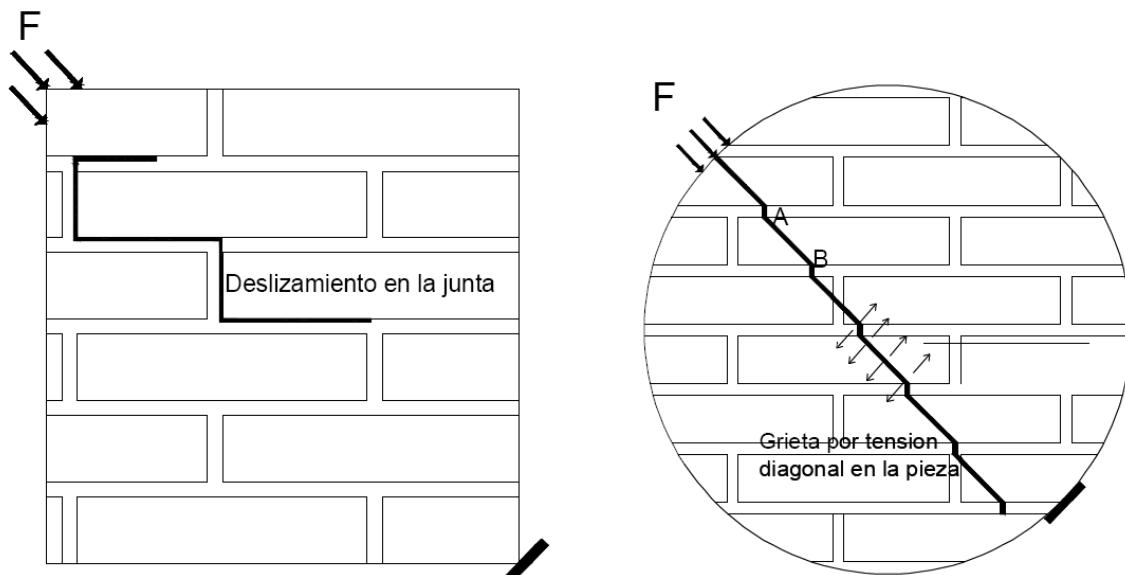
Fallas por deslizamiento y tensión diagonal en muros de mampostería (Fuente: Sánchez et al., 2007)
